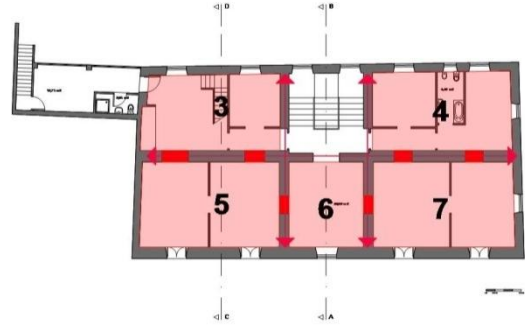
Planta do 1º Piso Linhas Estruturantes , Autor, 2017
